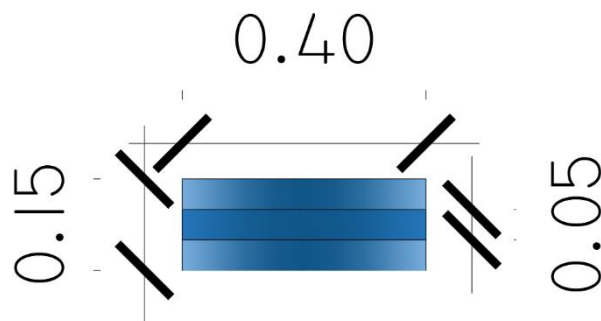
Vista en planta de la propuesta de ladrillo.
